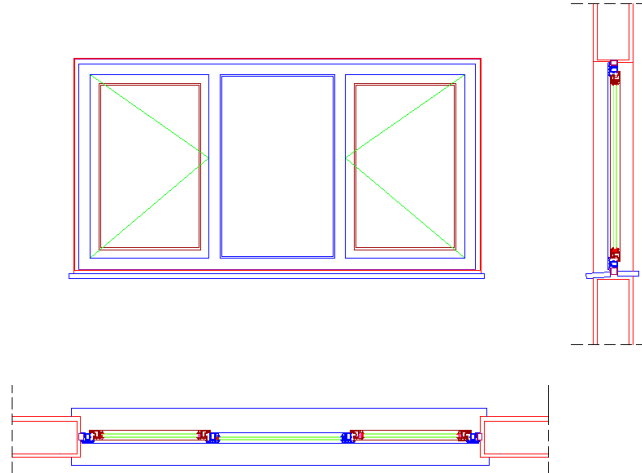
Görünüş çizimi için plan ve kesitten ölçülerin taşınması
